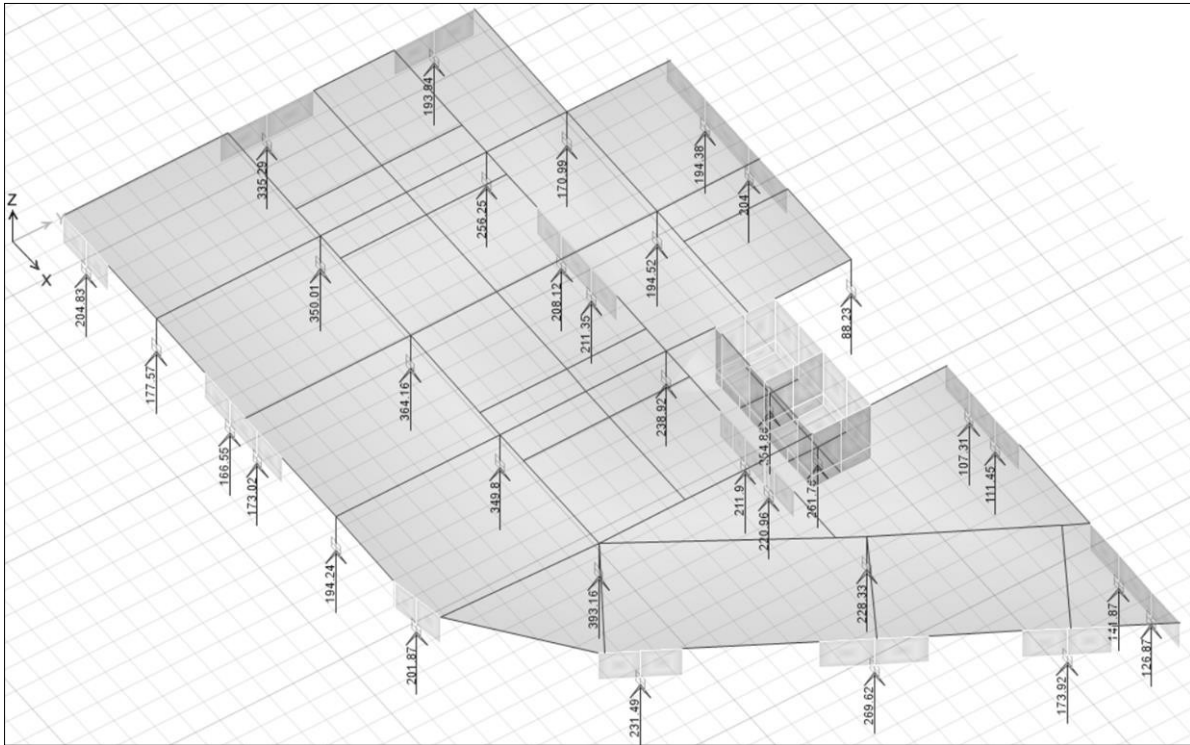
Vista de las cargas axiales de servicio actuantes sobre los dispositivos de aislamiento (ton).
